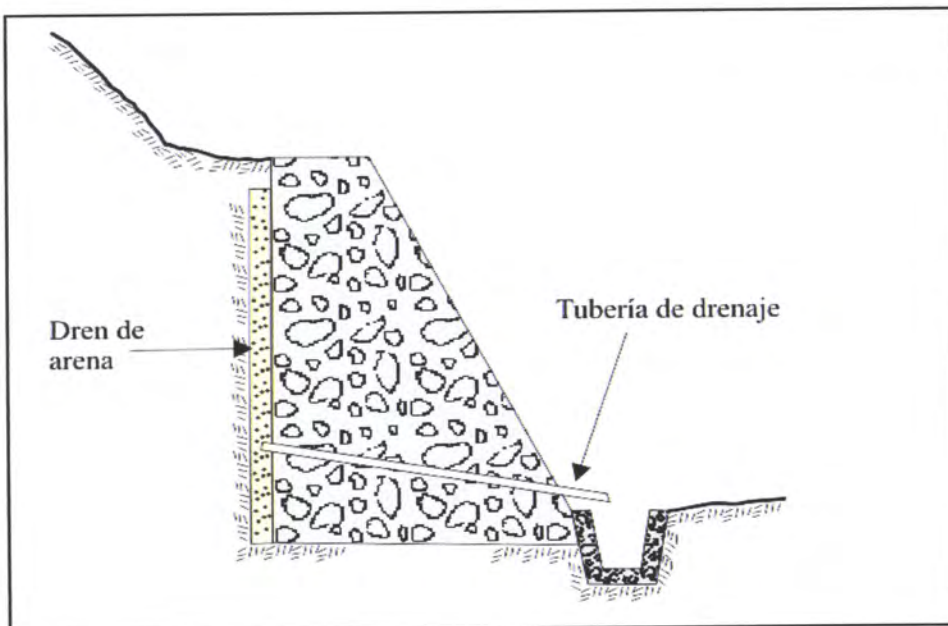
Muros de gravedad de concreto ciclópeo (tomado de Ingemmet, 2000).
